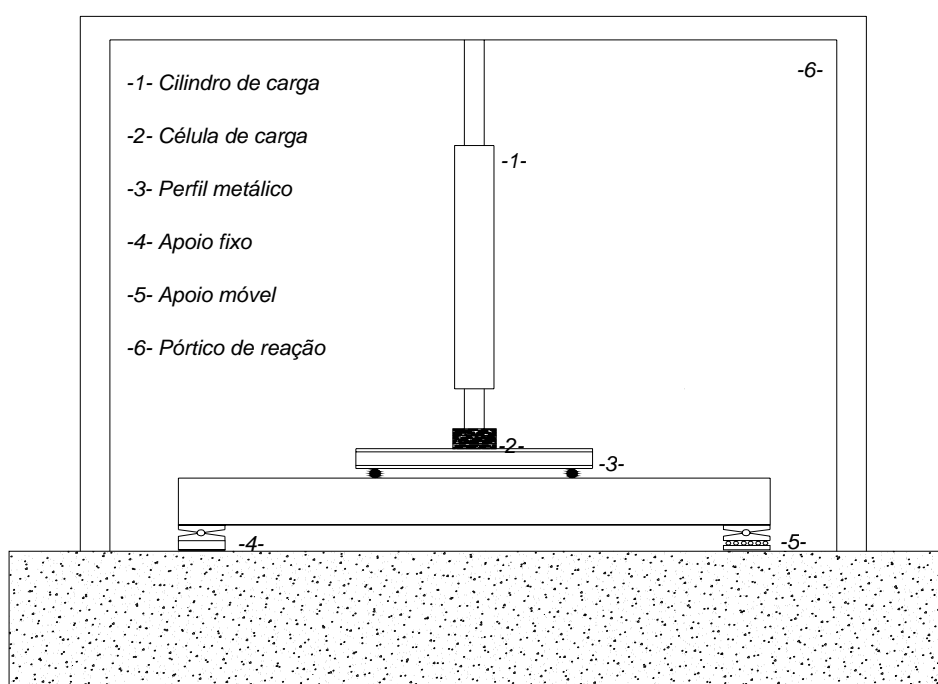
Ilustração esquemática do dispositivo de ensaio.
